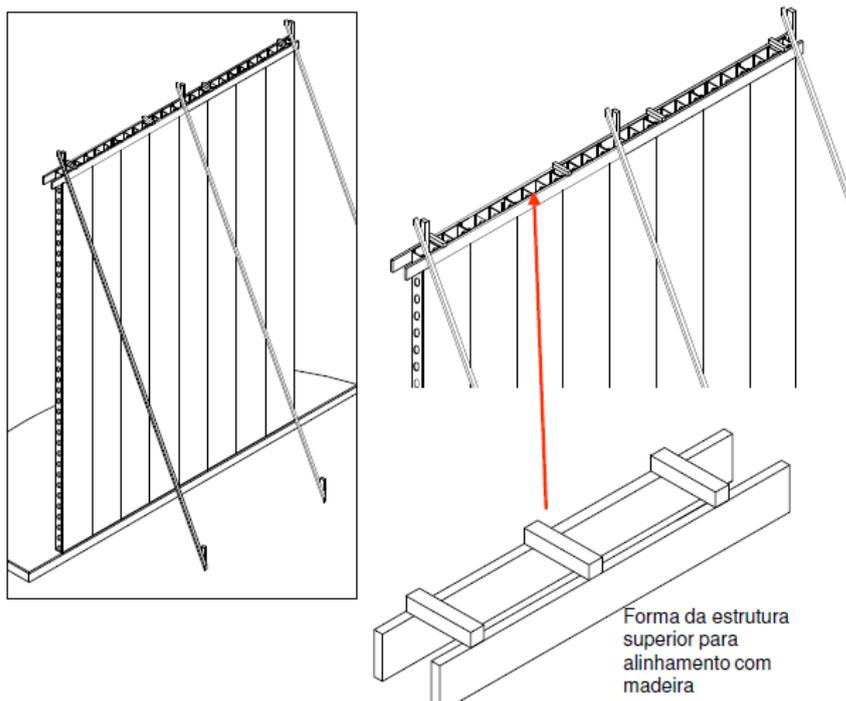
Posicionamento das barras de aço nos painéis de PVC
